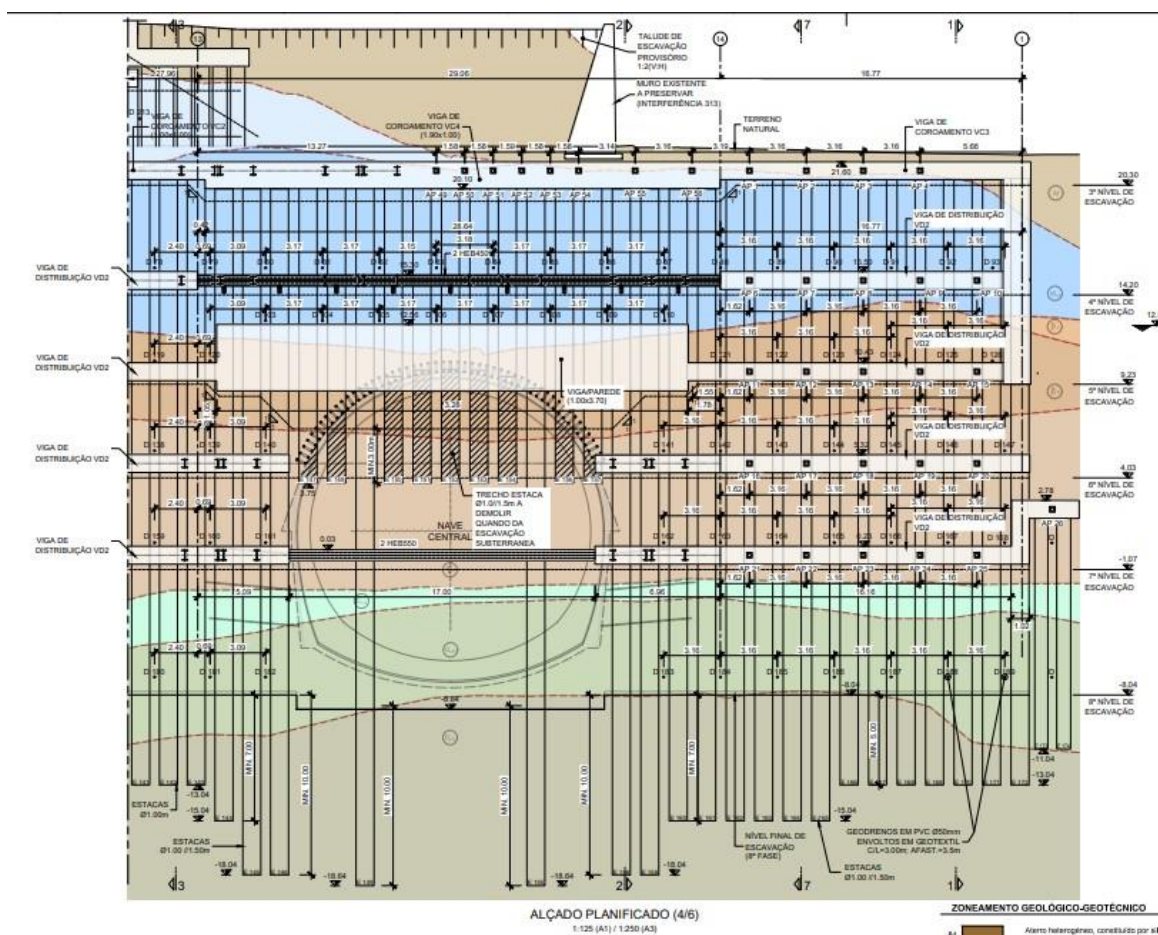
Contenção periférica do poço central da Estação de Santos - Alçado planejado na zona da interseção com a galeria (Fonte: RACS MSS PE GEO EST ESN DW 23307)
